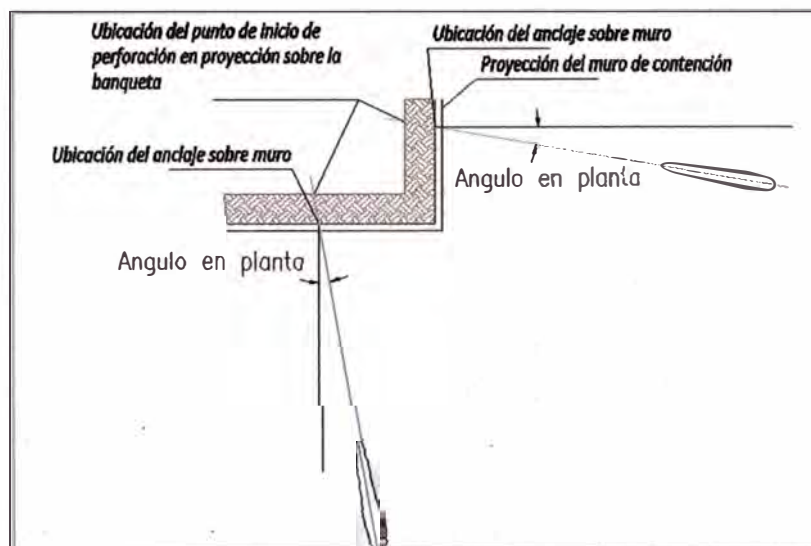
Replanteo en planta de la posición del anclaje sobre la banqueta.
